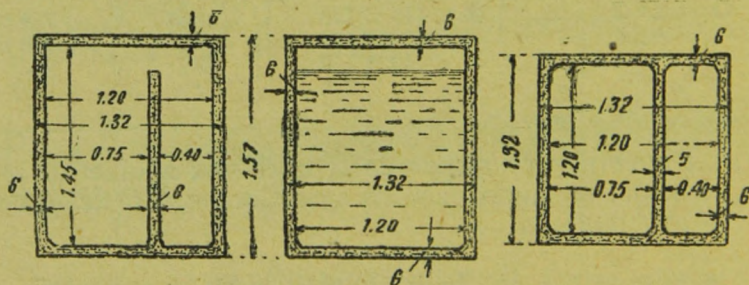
Железобетонный септик (разрез). Слева — вертикальный продольный разрез, в центре — вертикальный поперечный разрез, справа — горизонтальный разрез. Арматурой для железобетона служит прокатное железо.
